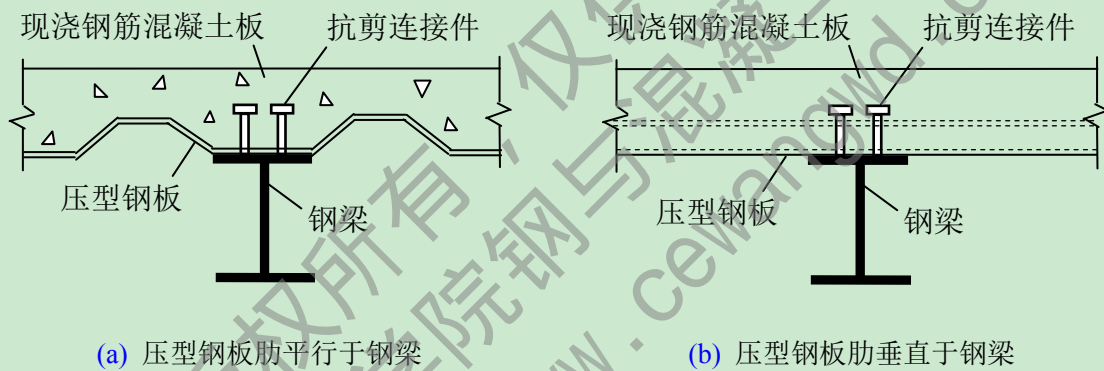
带压型钢板的现浇钢筋混凝土翼板组合梁
